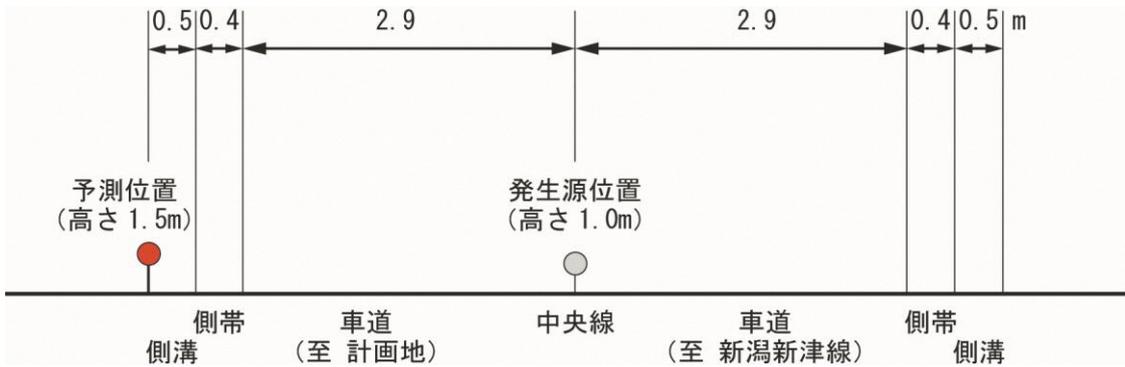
(5) 道路断面図 (No. 5 : 新施設東側沿道)
